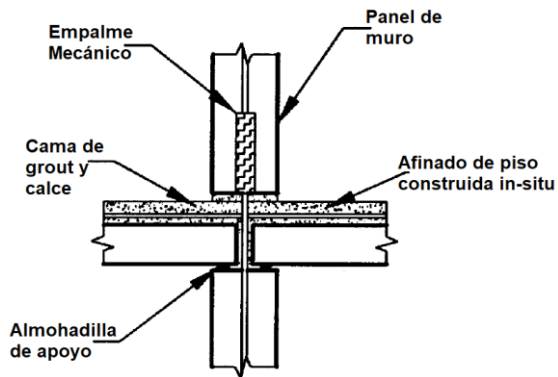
Losa apoyada sobre superficie de muro. Adaptado de (ACI 2001).
